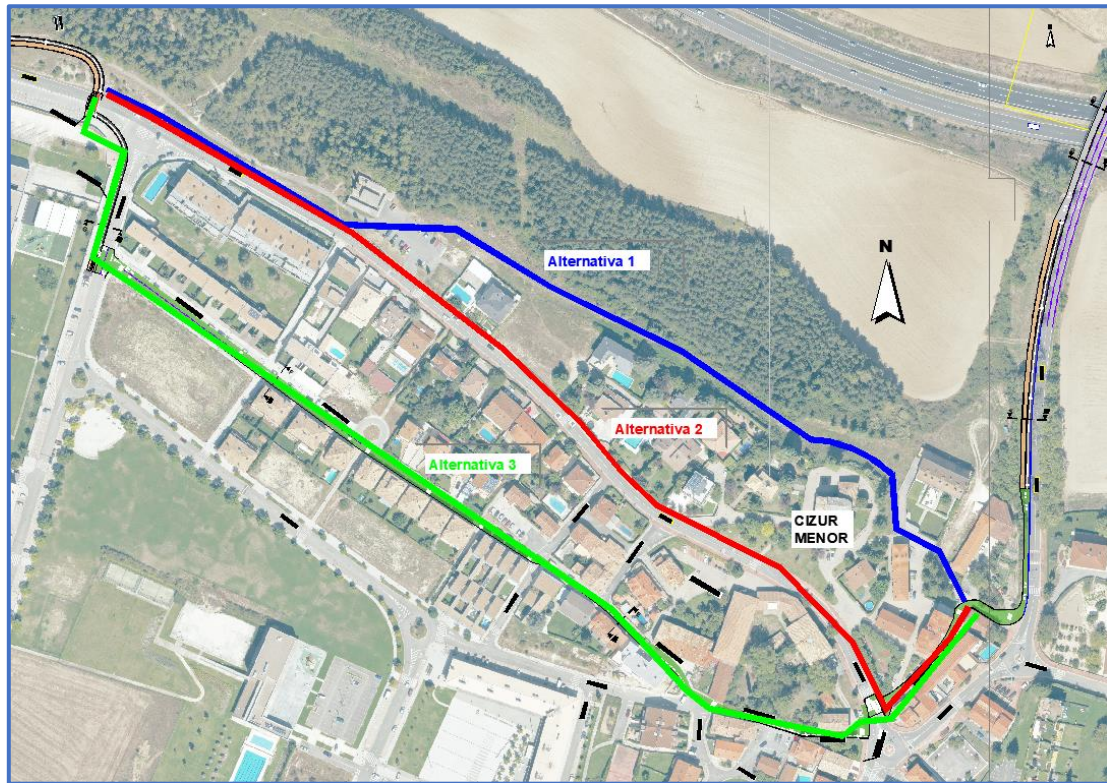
Planta de las tres alternativas de trazado analizadas para el tramo de Cizur Menor.
